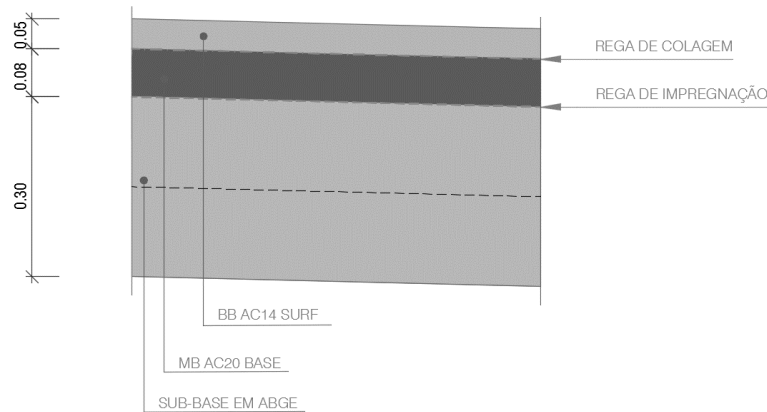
Pormenor da estrutura de pavimento proposta
